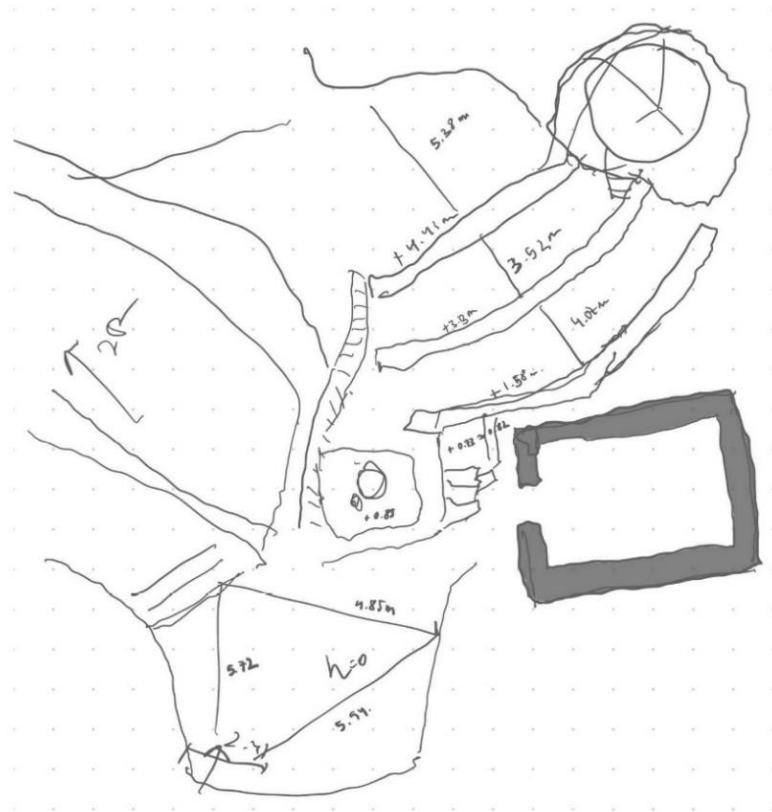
Apuntes y Fotografías Levantamiento Construcción Existente 1. Elaboración propia
